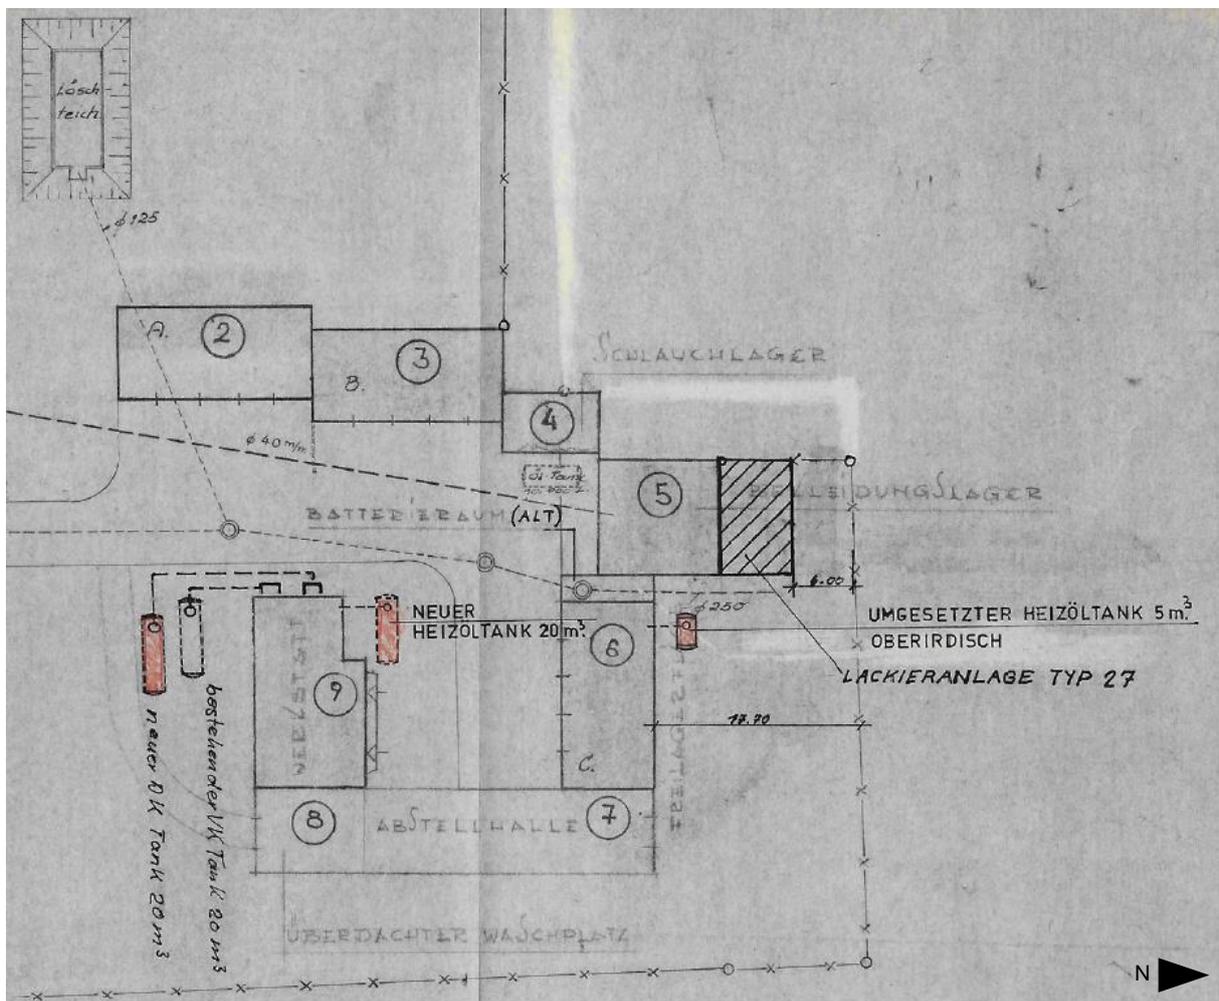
Lageplan 1979 (Stadt Bad Kreuznach)
